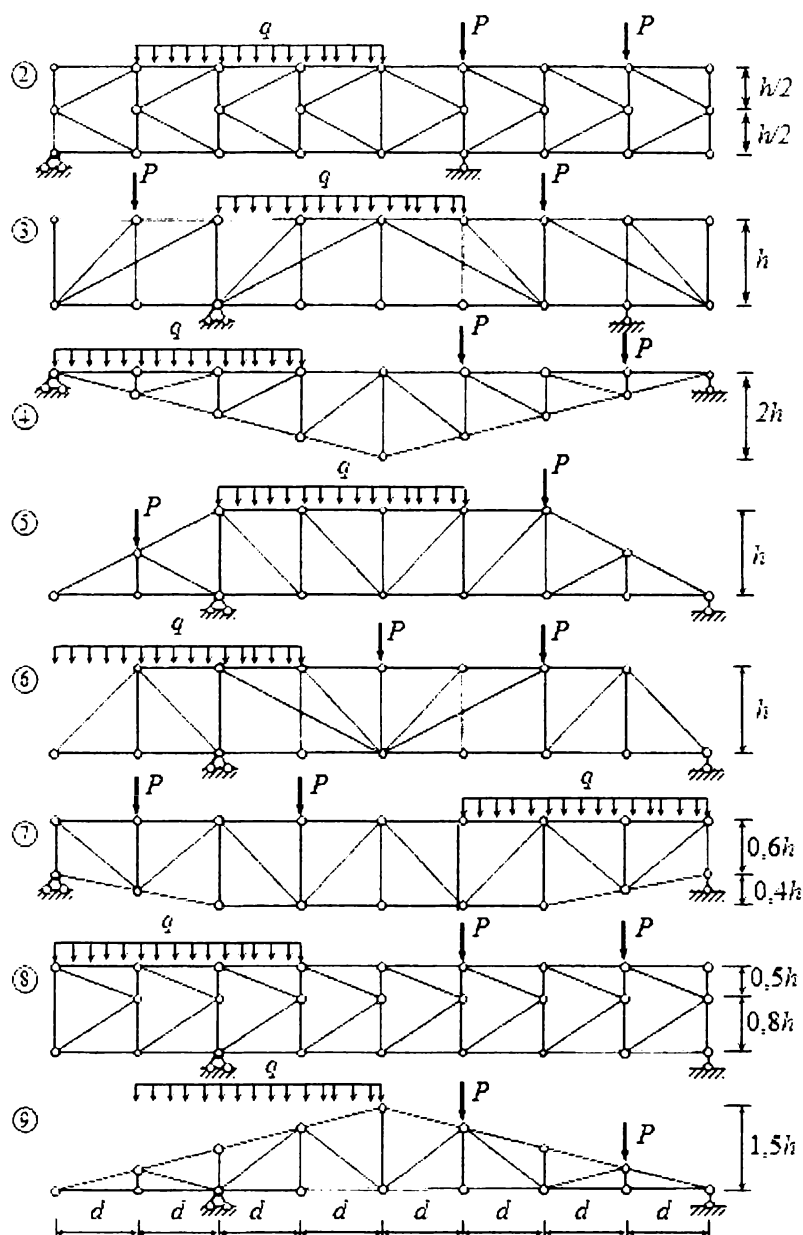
(продолжение) – Схемы ферм к выполнению расчётных работ
